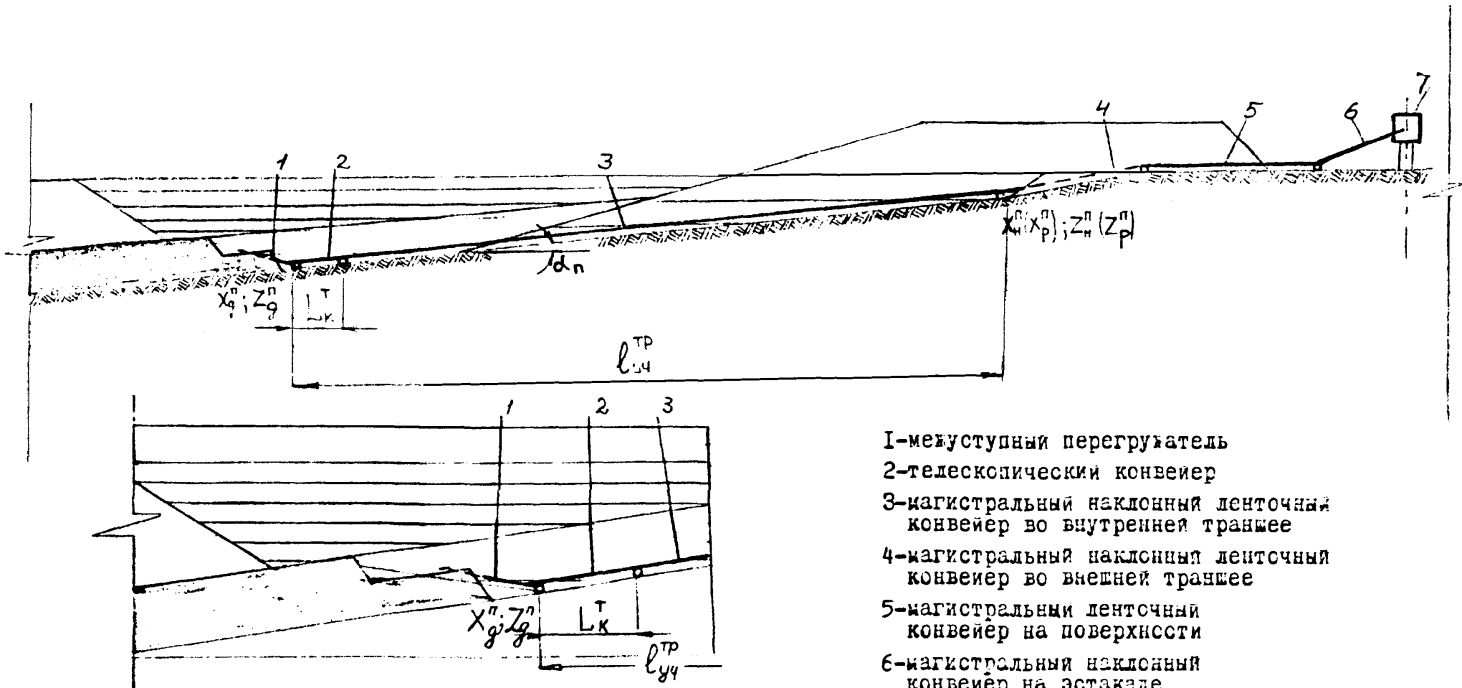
Поперечный профиль к вскрытию карьерного поля на добыче при использовании конвейерного транспорта (разработка угольного пласта наклонными слоями)
